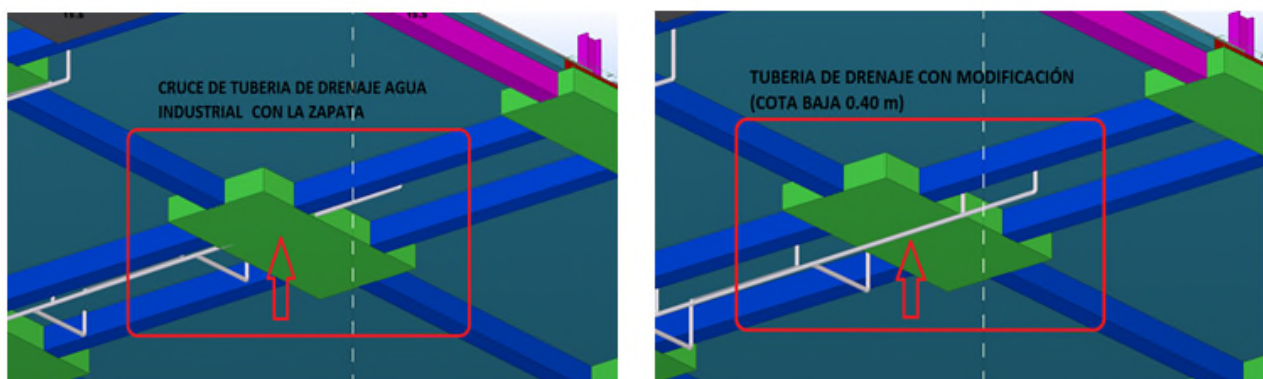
Ejemplo de resolución de interferencia de zapata con sistema de drenaje
